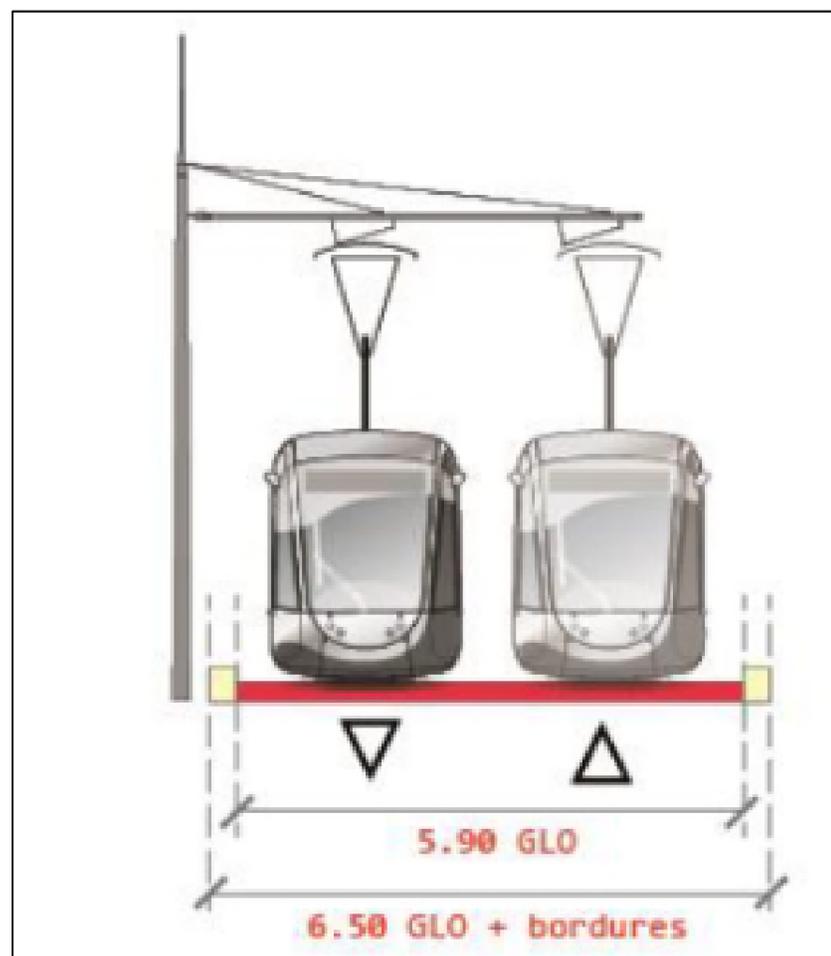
DIMENSIONS DE LA PLATERFOME POUR UNE INSERTION AXIALE FER LÉGER EN MILIEU URBAIN
